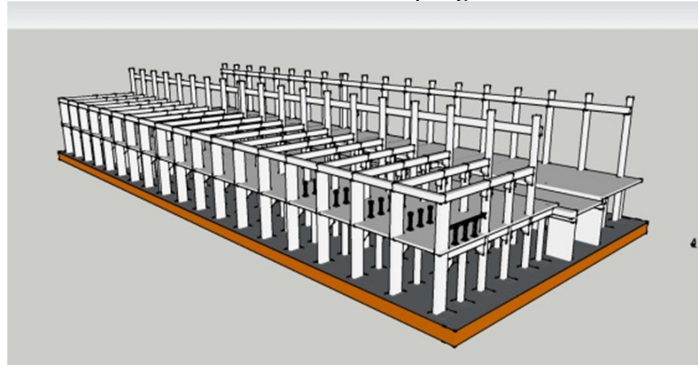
27 BM1 Pilecap Dan Ground Beam.
